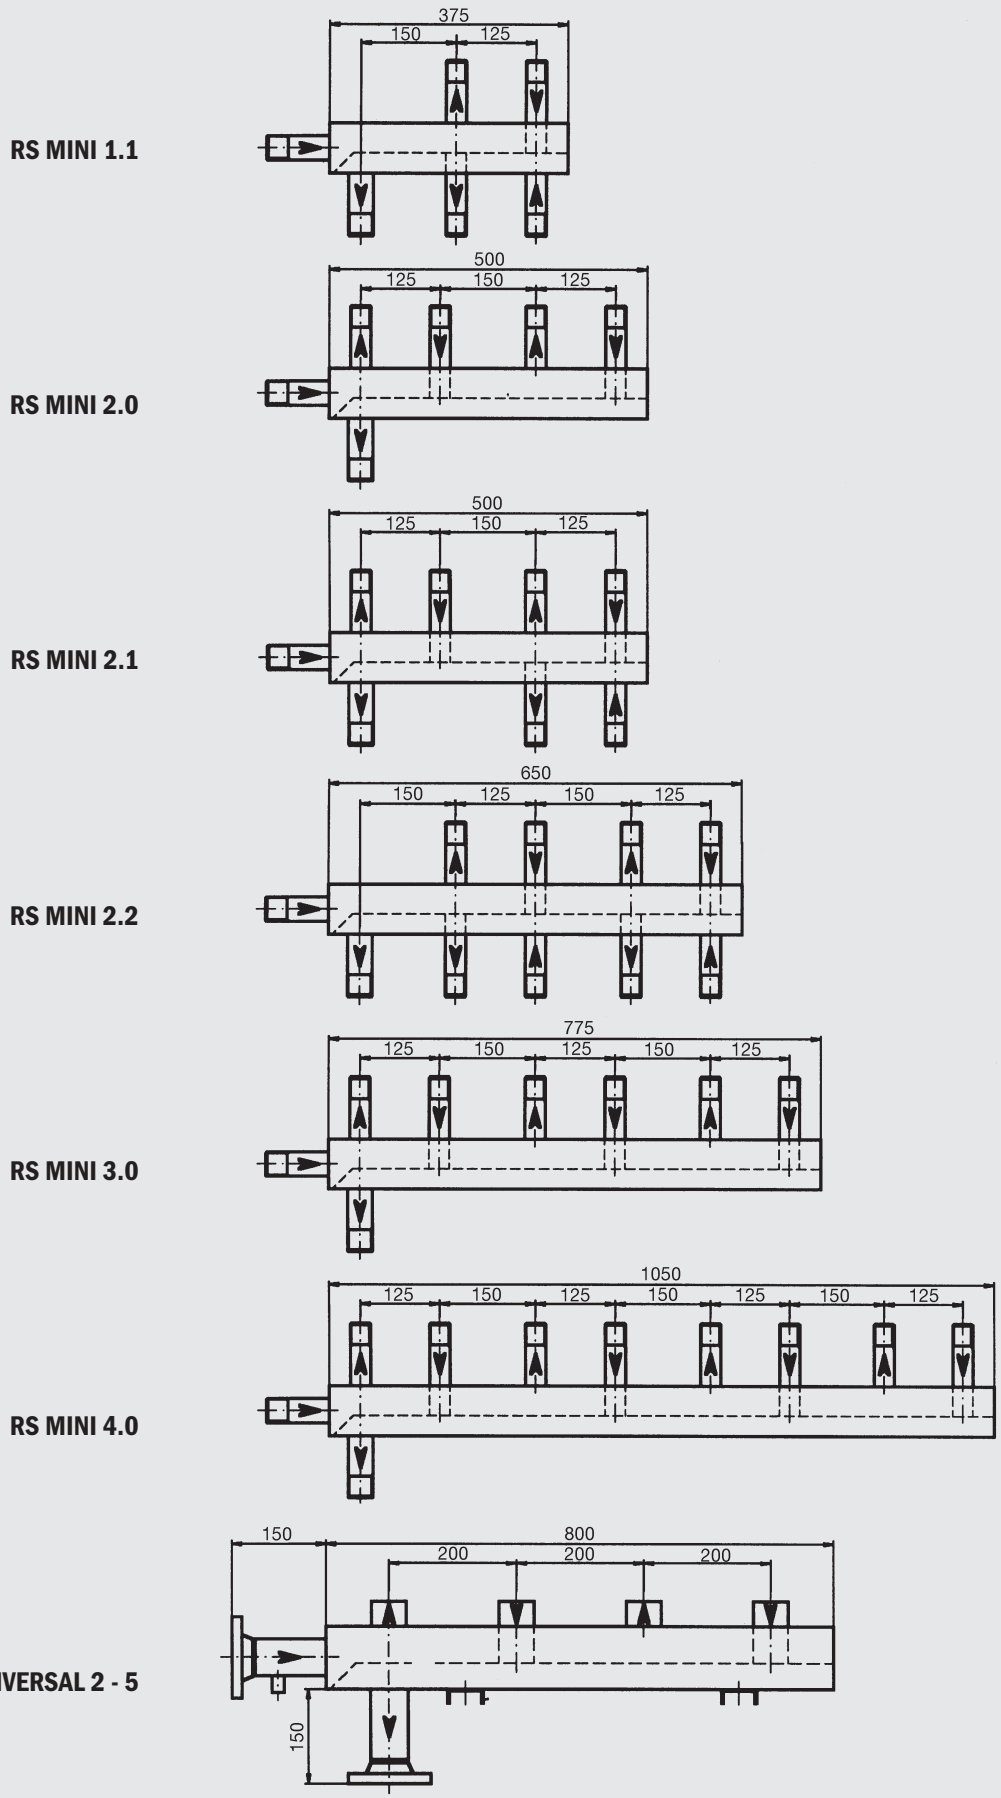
Hlavní přívod uprostřed, zpátečka vyvedena spodem – optimální řešení
